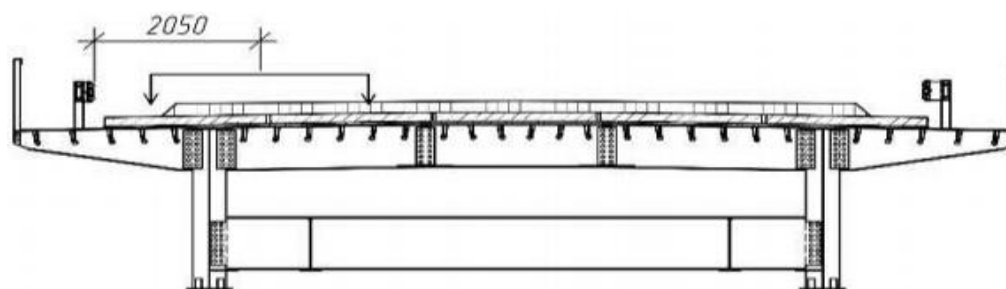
Схема размещения на пролетном строении № 1 временной нагрузки НК (разработано Валиевым Ш.Н.)
